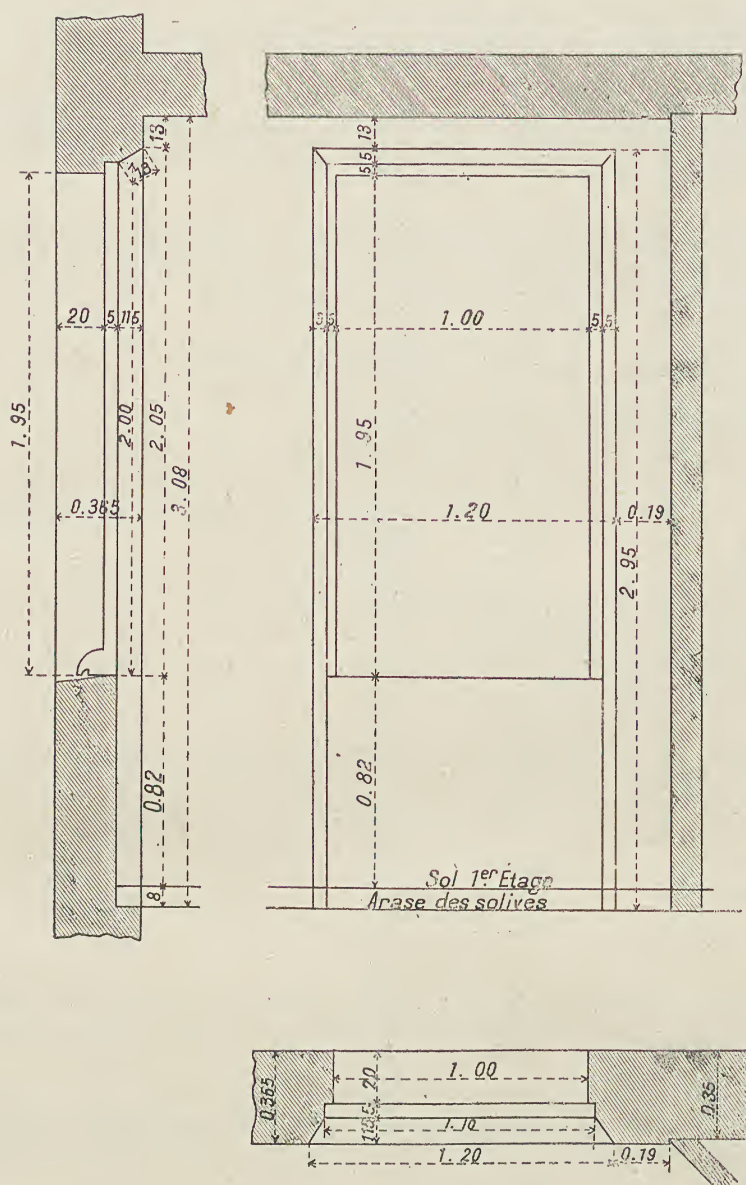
à 696. — Coupe, élévation intérieure et plan.
